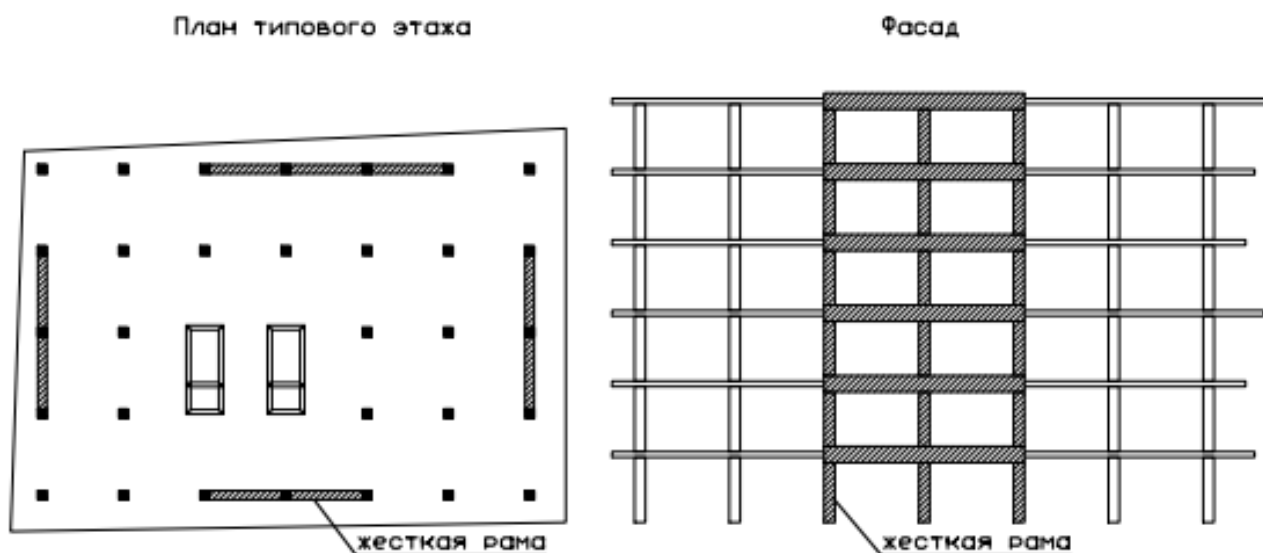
План и фасад здания с плоскими безбалочными перекрытиями пролетами более 8 метров и рамами жесткости (диафрагмами)
